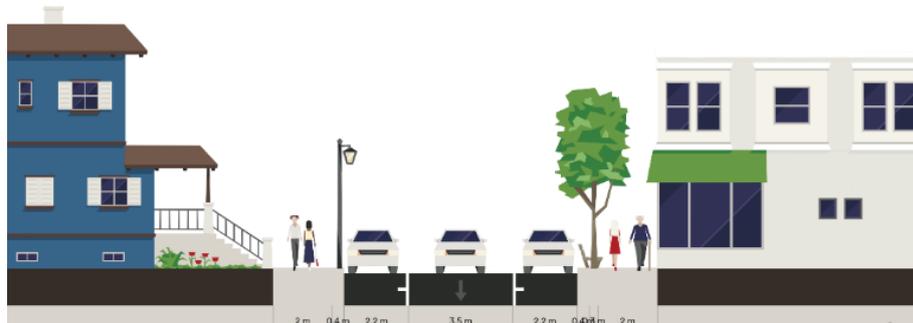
Ejemplo calles en casco urbano con anchura libre de paso insuficiente
